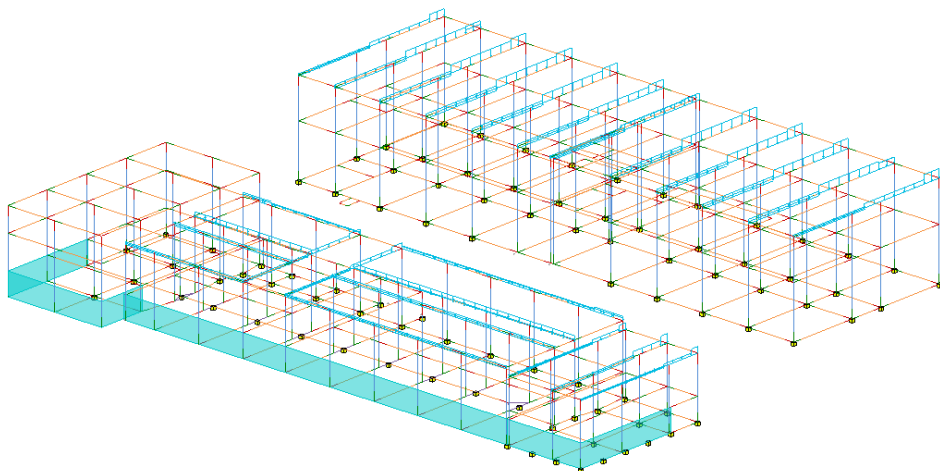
Vista 3D del modelo analítico con las cargas de viento sur sobre cubierta
